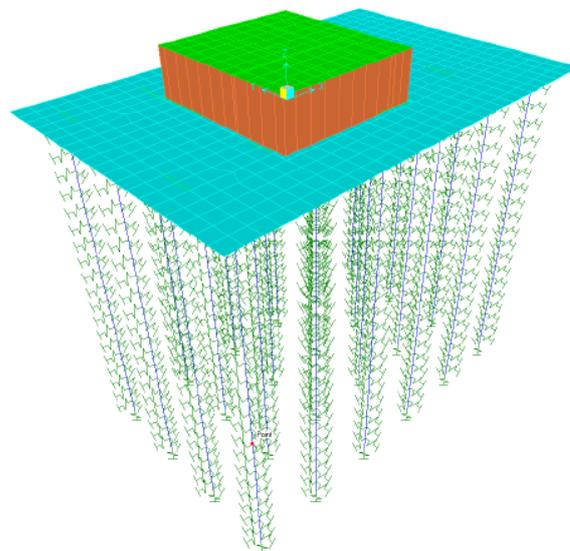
Cimentación mediante pilotes. Planta de cimentación.
